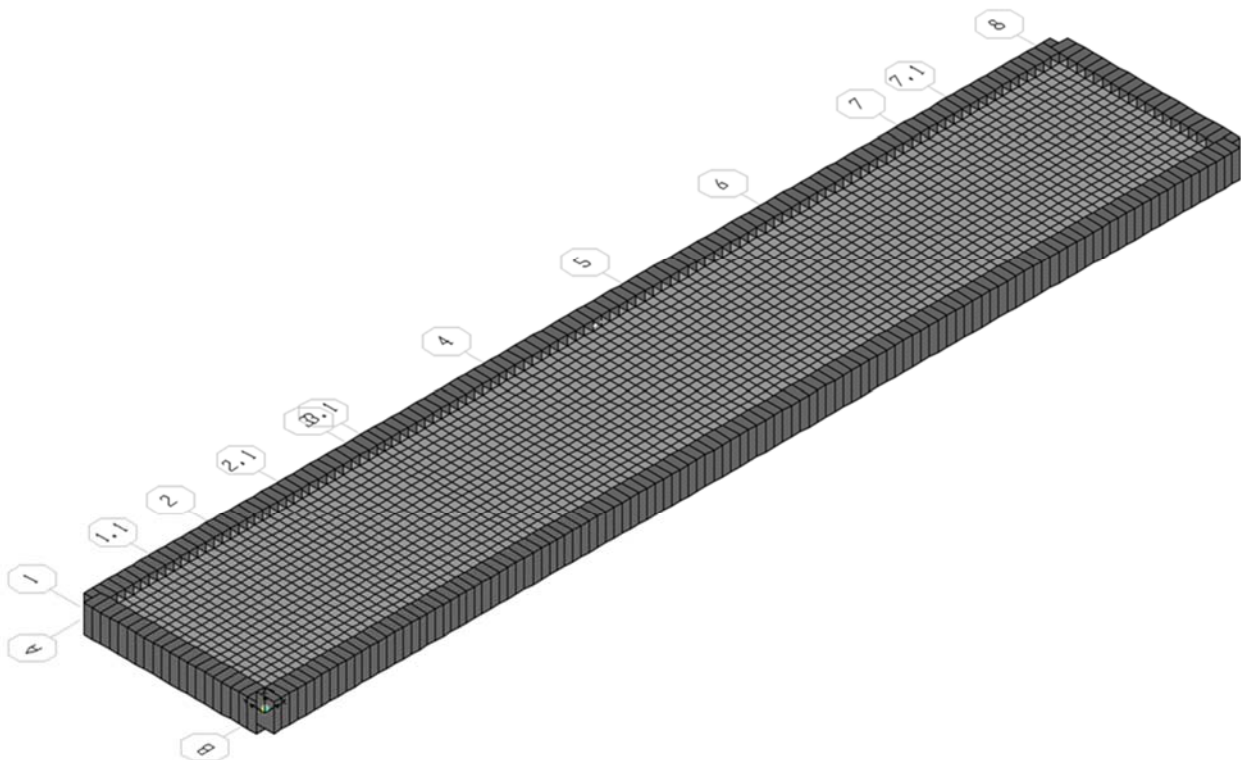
Vista assonometrica modello struttura in elevazione - numerazione elementi frame
